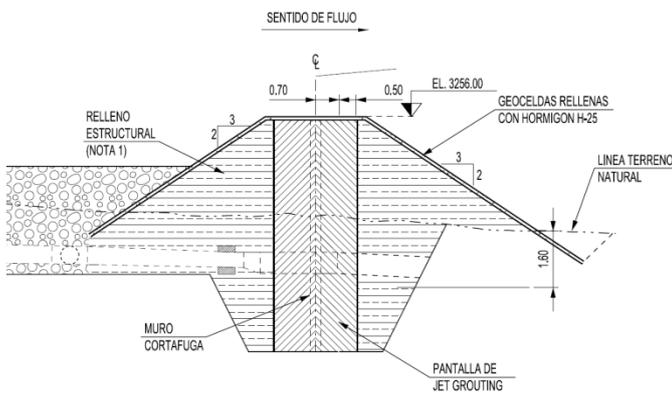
Vista en Corte Transversal de la Pantalla de Jet Grouting.
